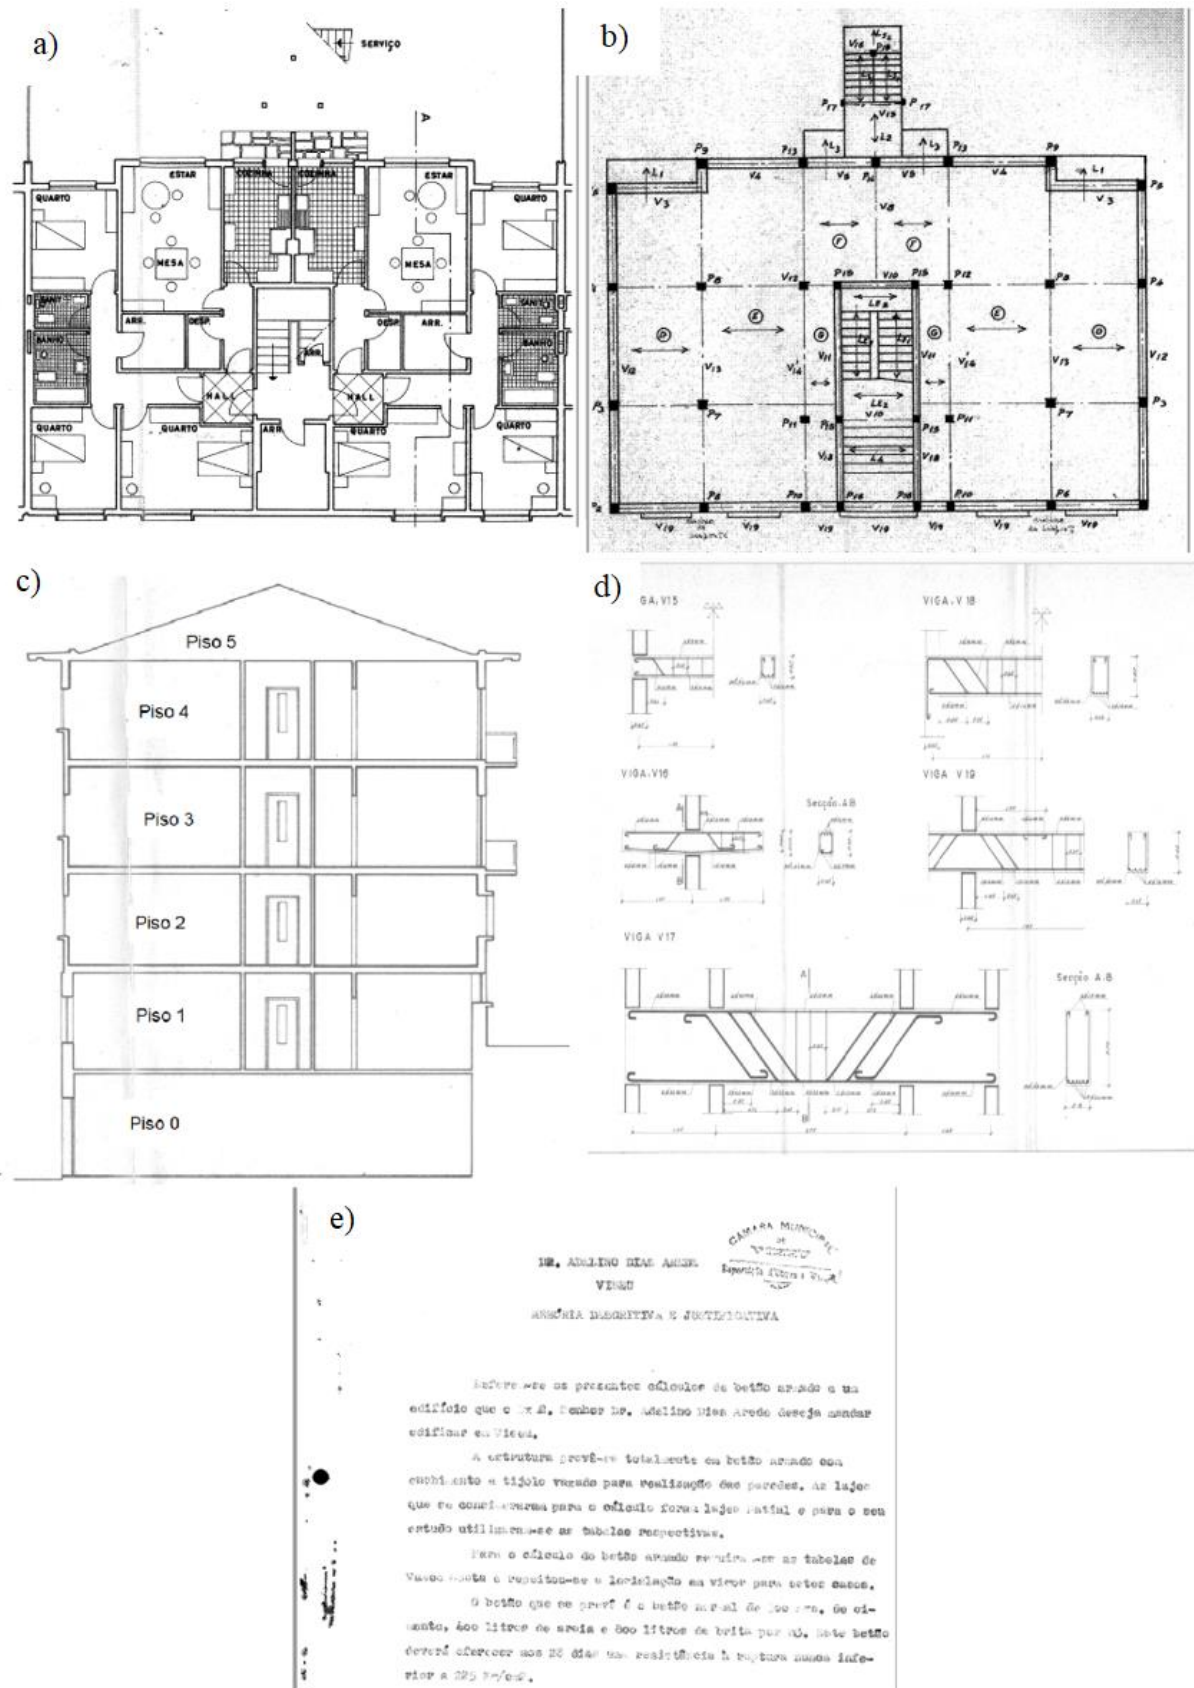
Elementos do projeto do edifício do estudo de caso: a) Planta arquitetónica; b) Planta estrutural; c) Corte com nomenclatura dos pisos; d) disposições de armadura; e) excerto de memória de cálculo.
